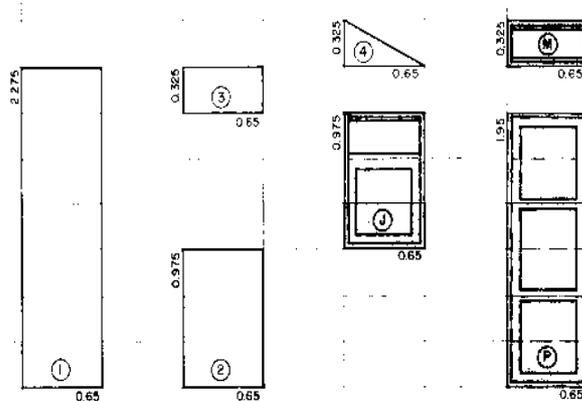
painéis de vedação e aberturas do projeto para Cajueiro Seco, 1962.
